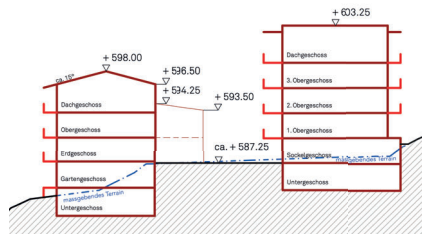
Schemaschnitte: im Baubereich A1 (Unterhaus) wird ein flachgeneigtes Satteldach, im Baubereich B (Oberhaus) ein Flachdach vorgeschrieben...
